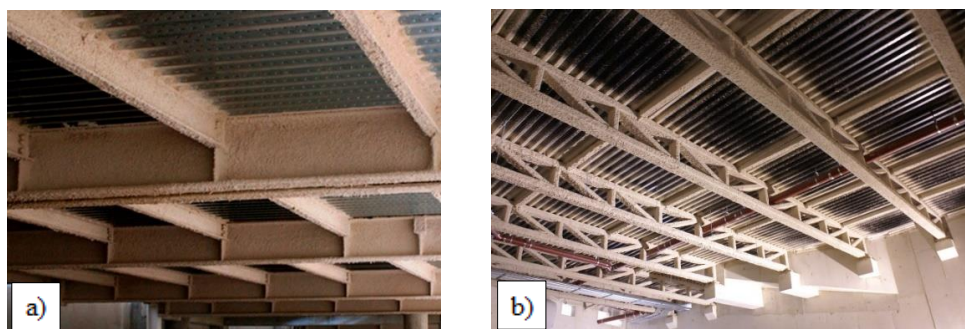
Argamassas projetadas: a) Proteção em vigas de piso [63]; b) Proteção em vigas de piso treliçadas [64].
